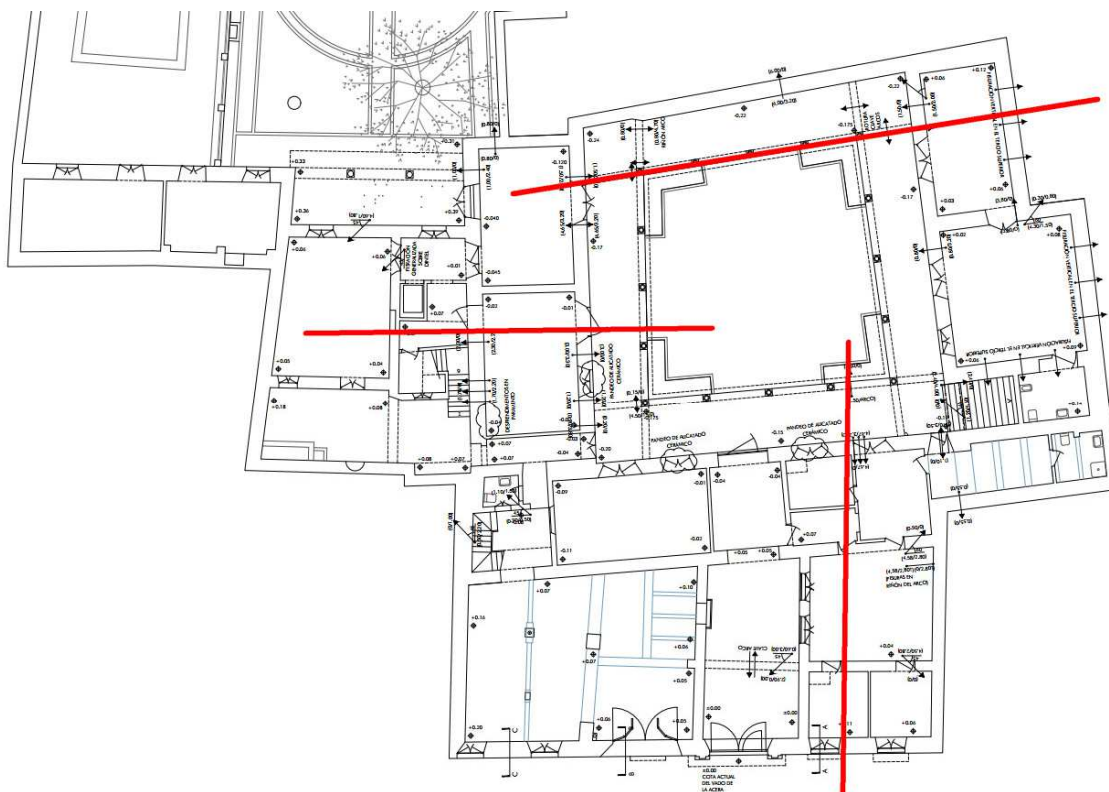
Principales familias de grietas y fisuras en muros
